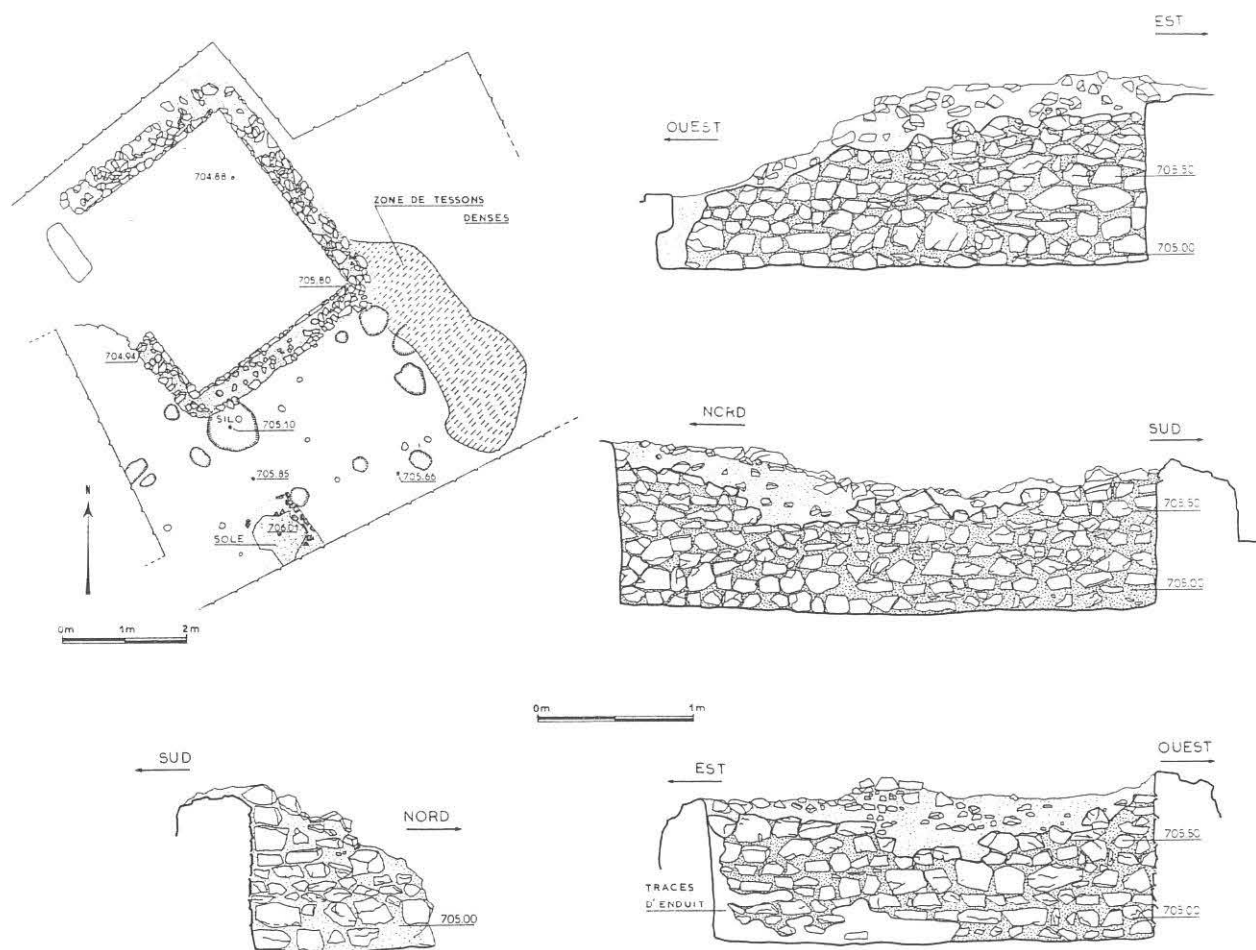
Relevé des murs de la cave située à l'extérieur de la Porte du Rebout, plans et élévations.
